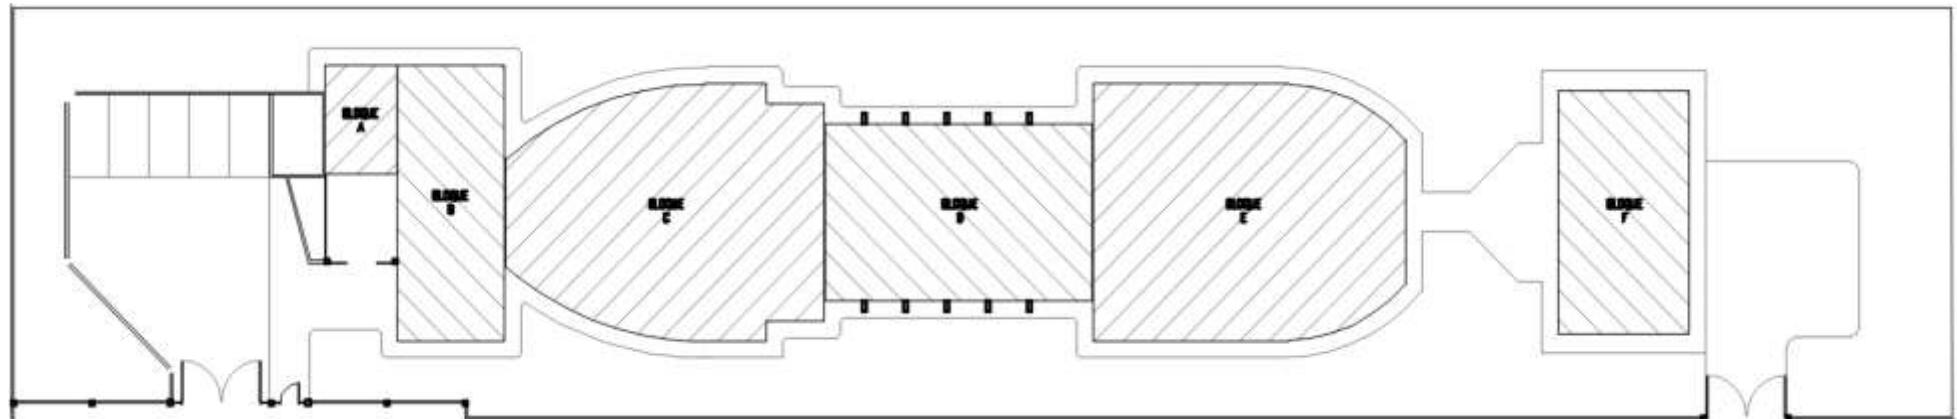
Planta 1er Piso – Distribución de bloques estructurales
